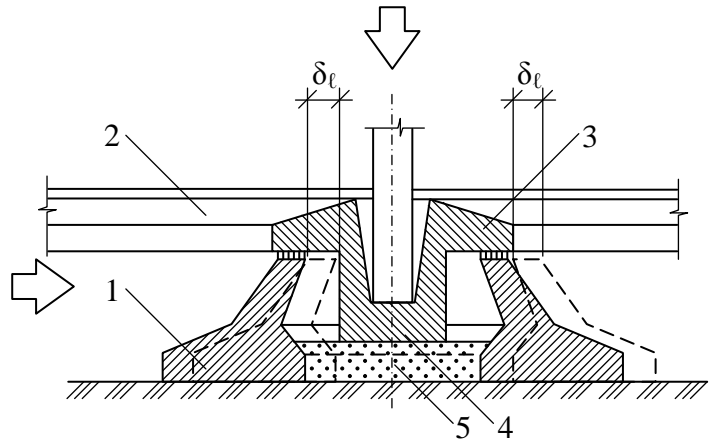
Окремий фундамент, який зміщується в горизонтальному напрямі: 1 – фундаментний блок; 2 – зв'язки-розпірки; 3 – консольні виступи; 4 – підколонник; 5 – піщана подушка
